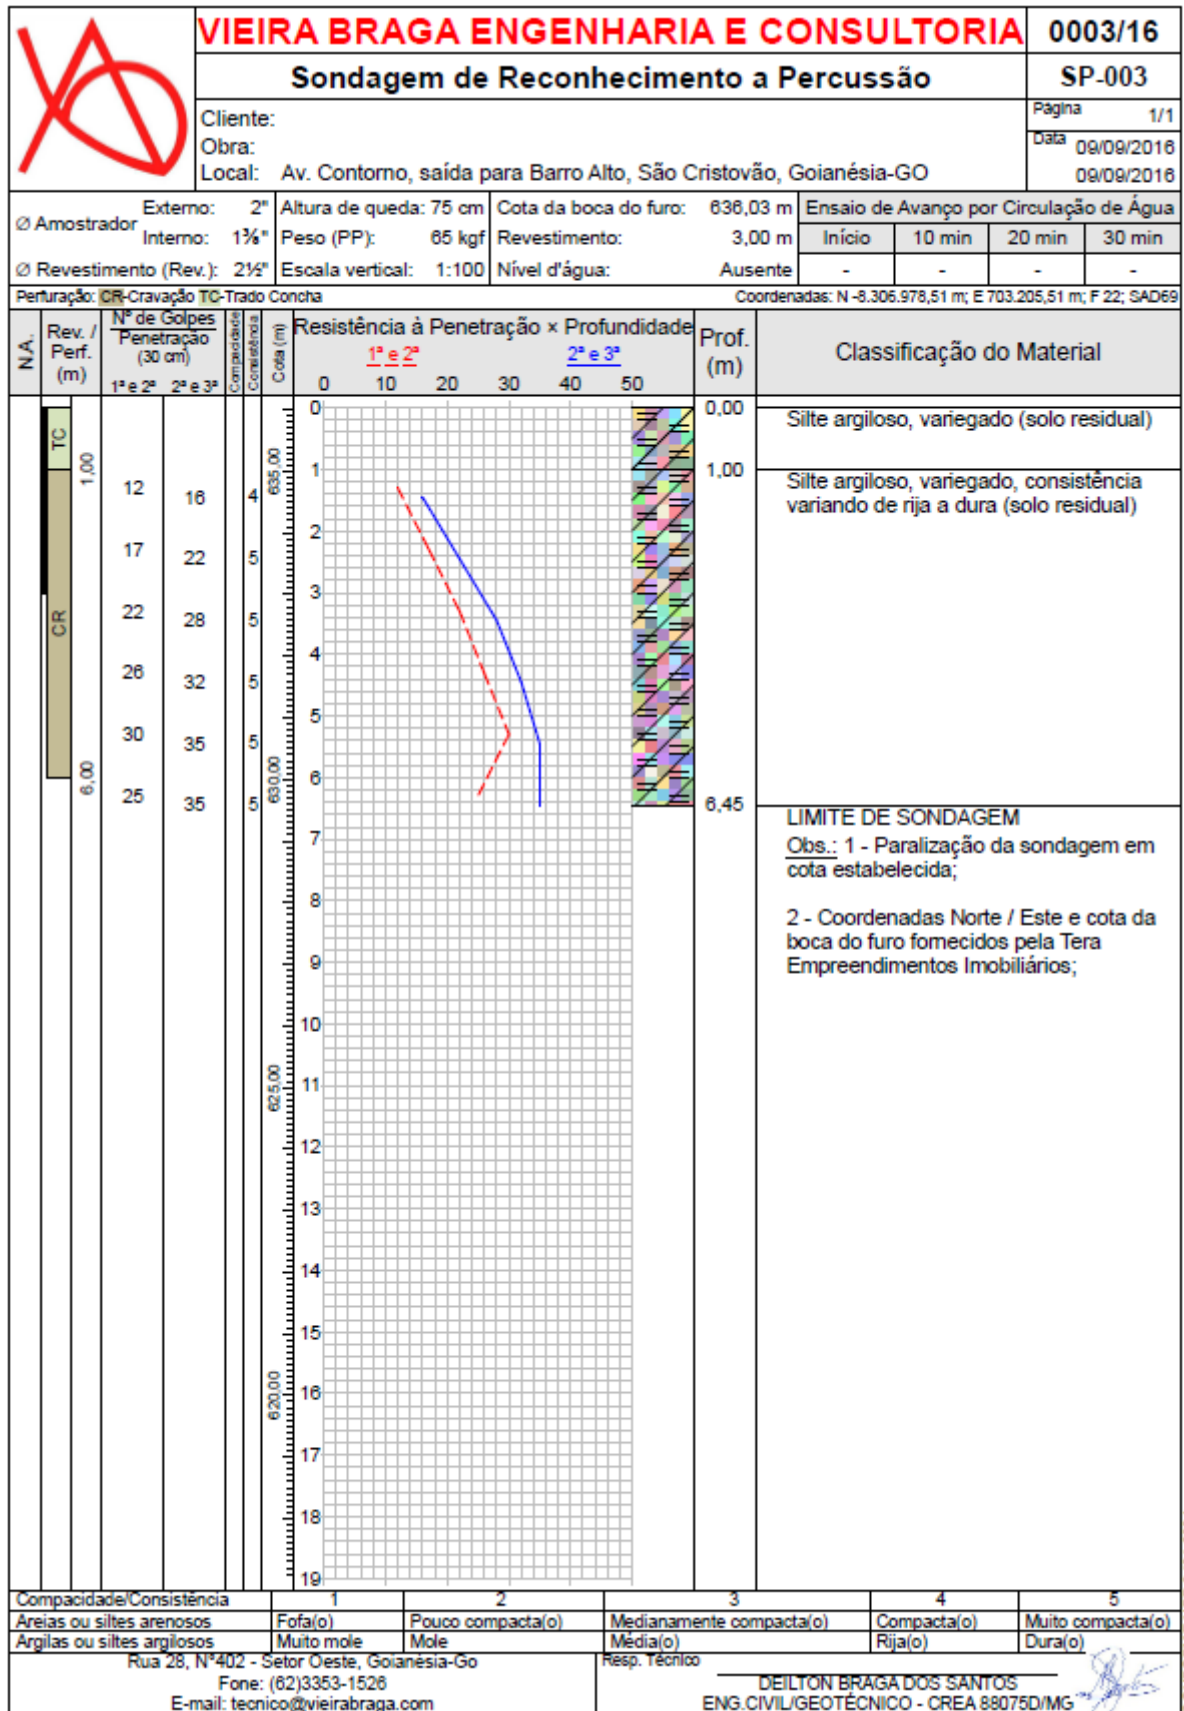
Laudo 02 – SPT/standard penetration test – Fonte: Vieira Braga Engenharia e Consultoria
